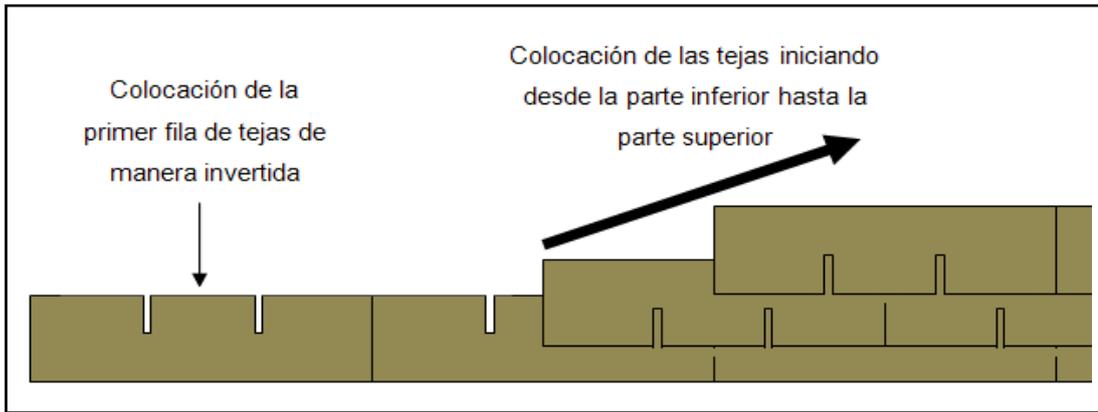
Colocación de la teja asfáltica en traslapes, iniciando desde la parte inferior hasta la parte superior del techo.
